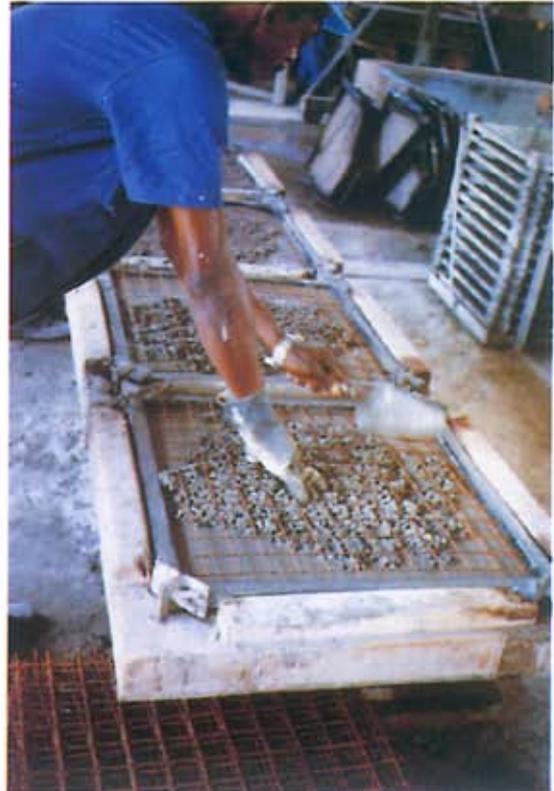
Fôrma simples para fabricação de placas de piso
